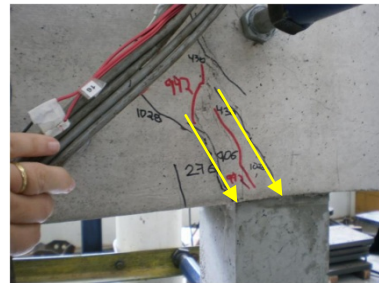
Configuração final de fissuras modelo B127P500R1
